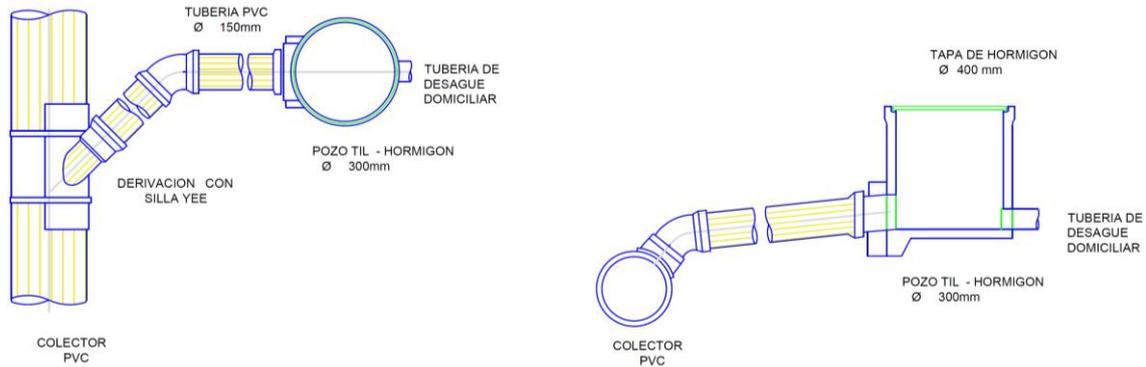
Detalle de conexión domiciliar en planta y perfil (Fuente propia, 2018)
